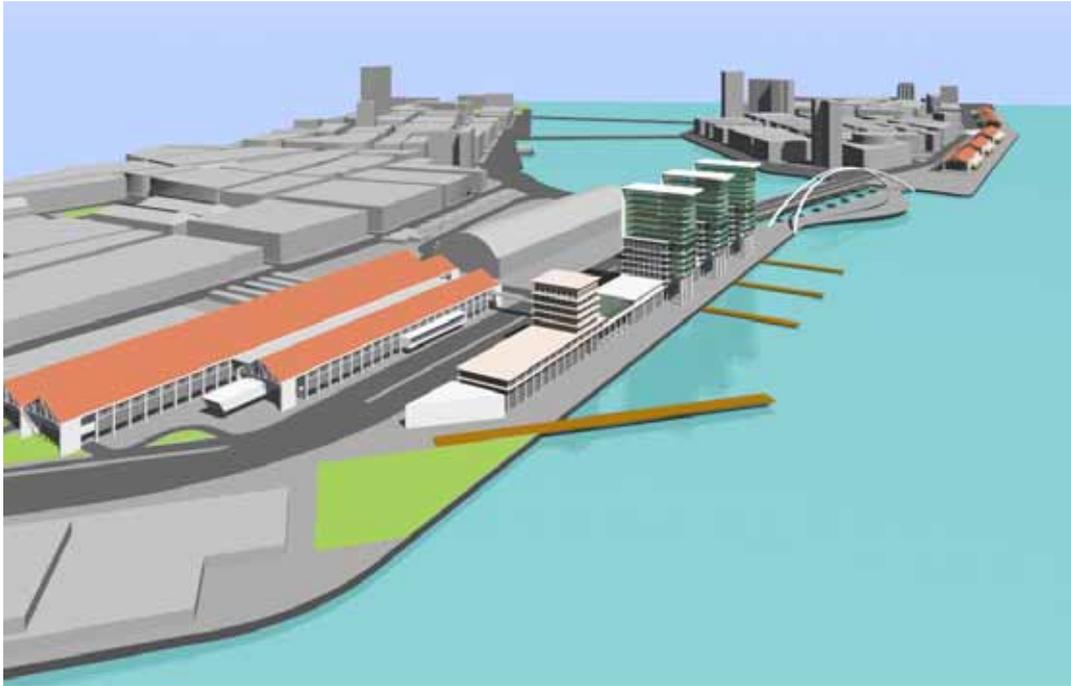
Vista geral da proposta a partir do Cais de Santa Rita.
